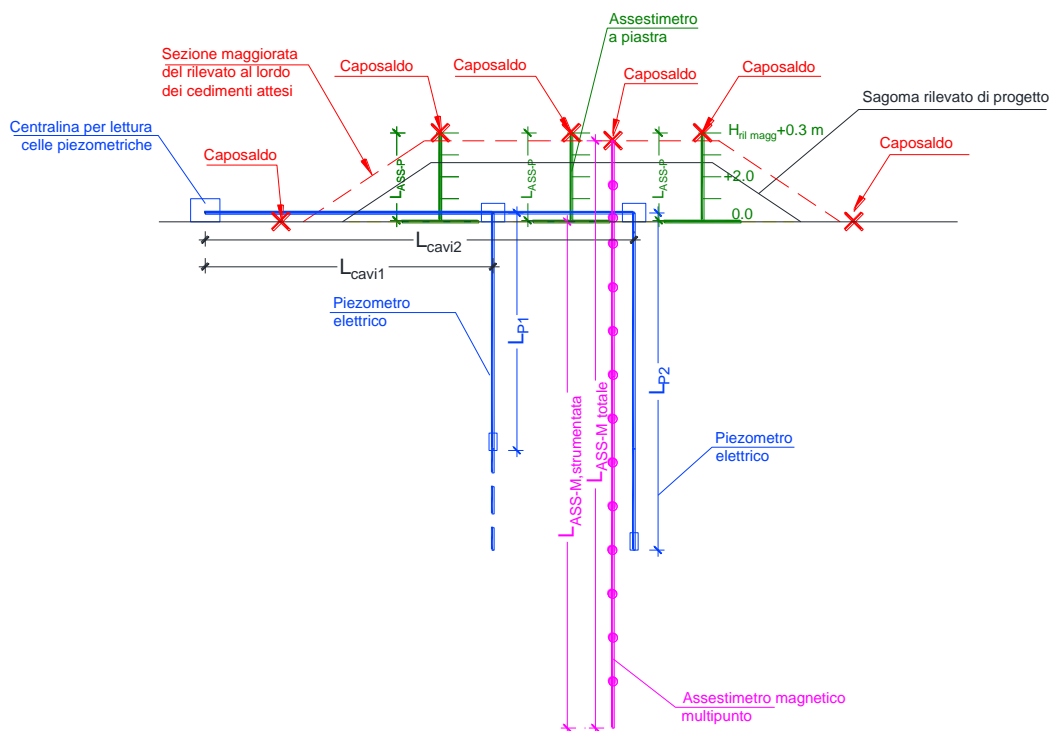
Sezione strumentata – Schema indicativo della disposizione della strumentazione di monitoraggio.
